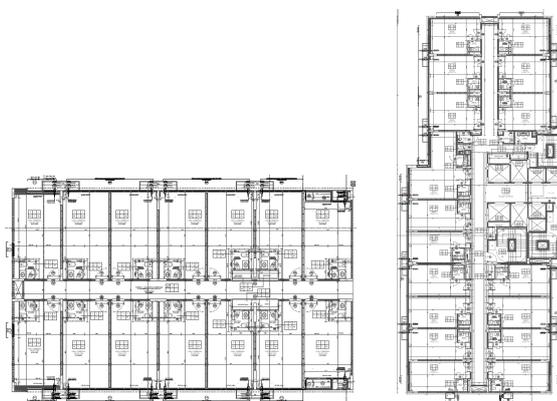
Plantas baixas das Torre A e B, respectivamente
